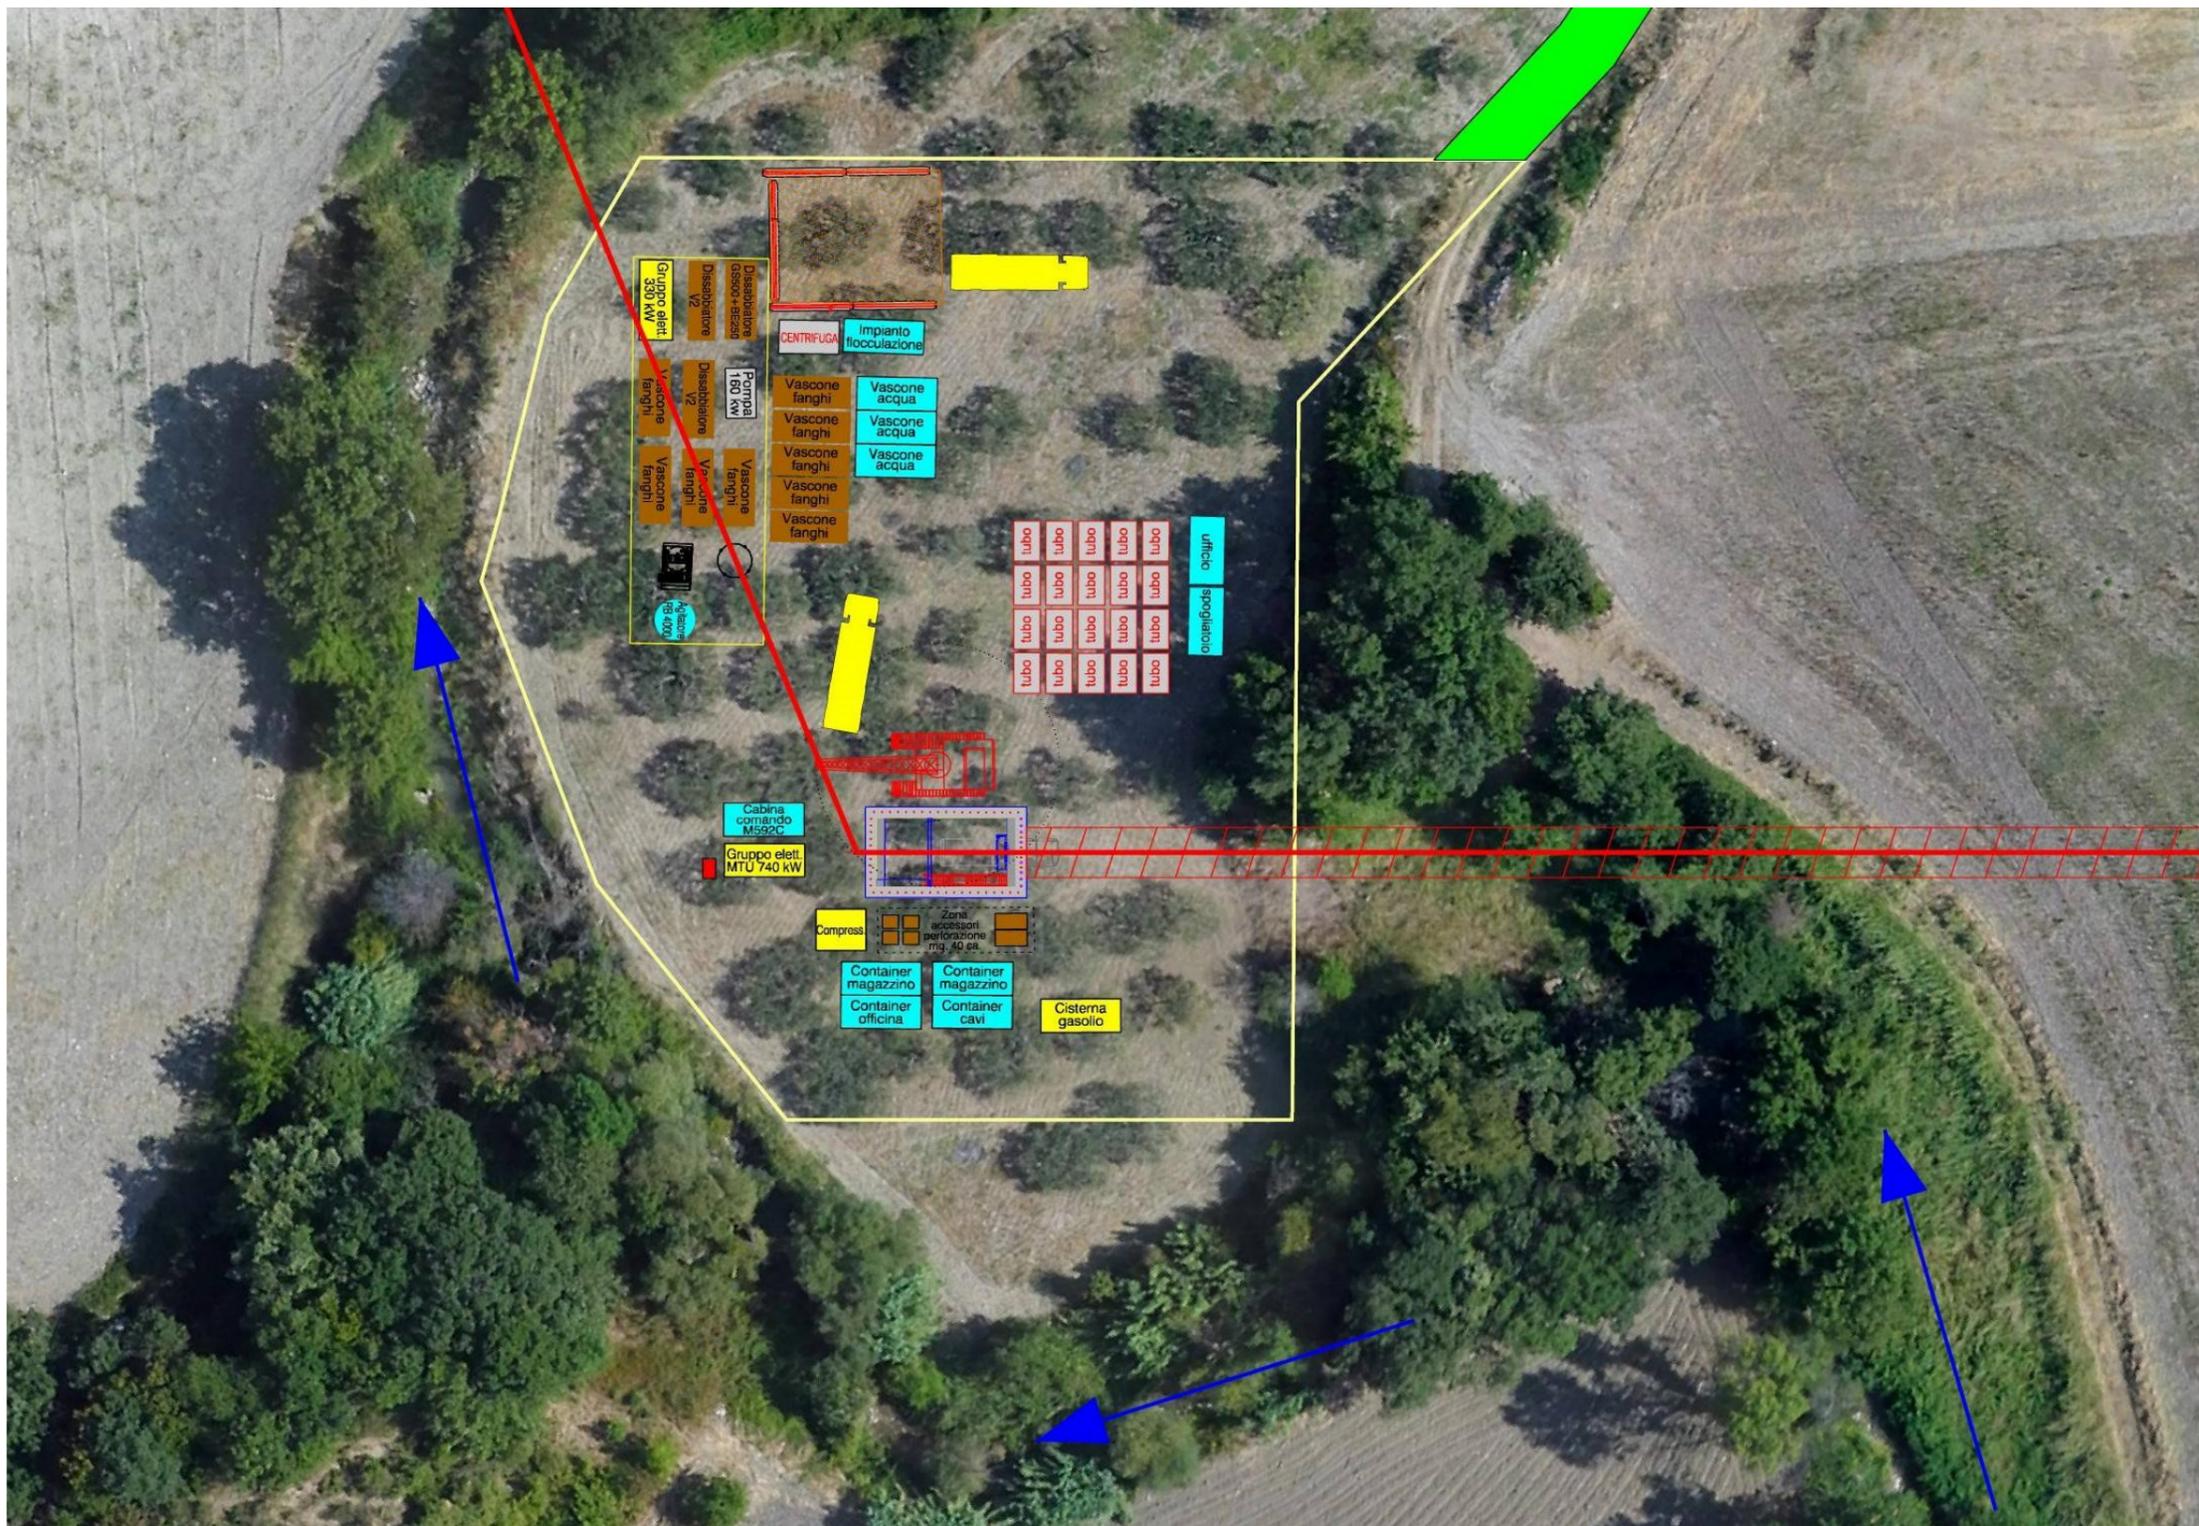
Vista aerea dell'area cantiere Microtunnel "Masseria Graziano (Schema indicativo)
